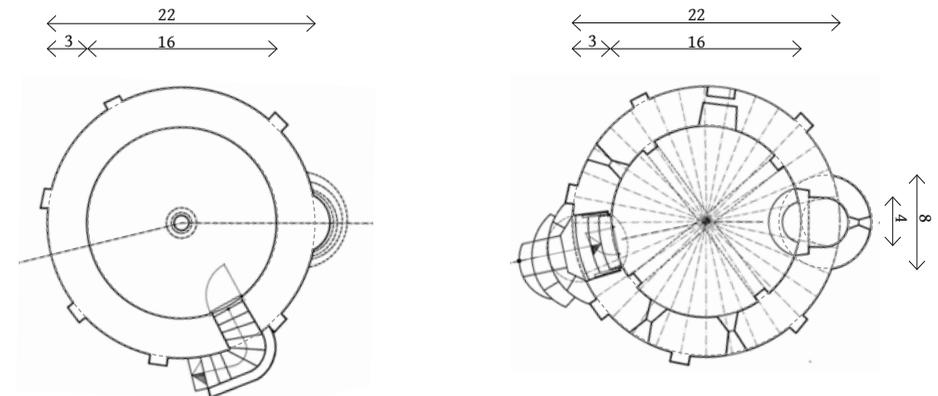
Grundrisse mit den kodierten Hauptmaßen in Fuß. CA 2016.
